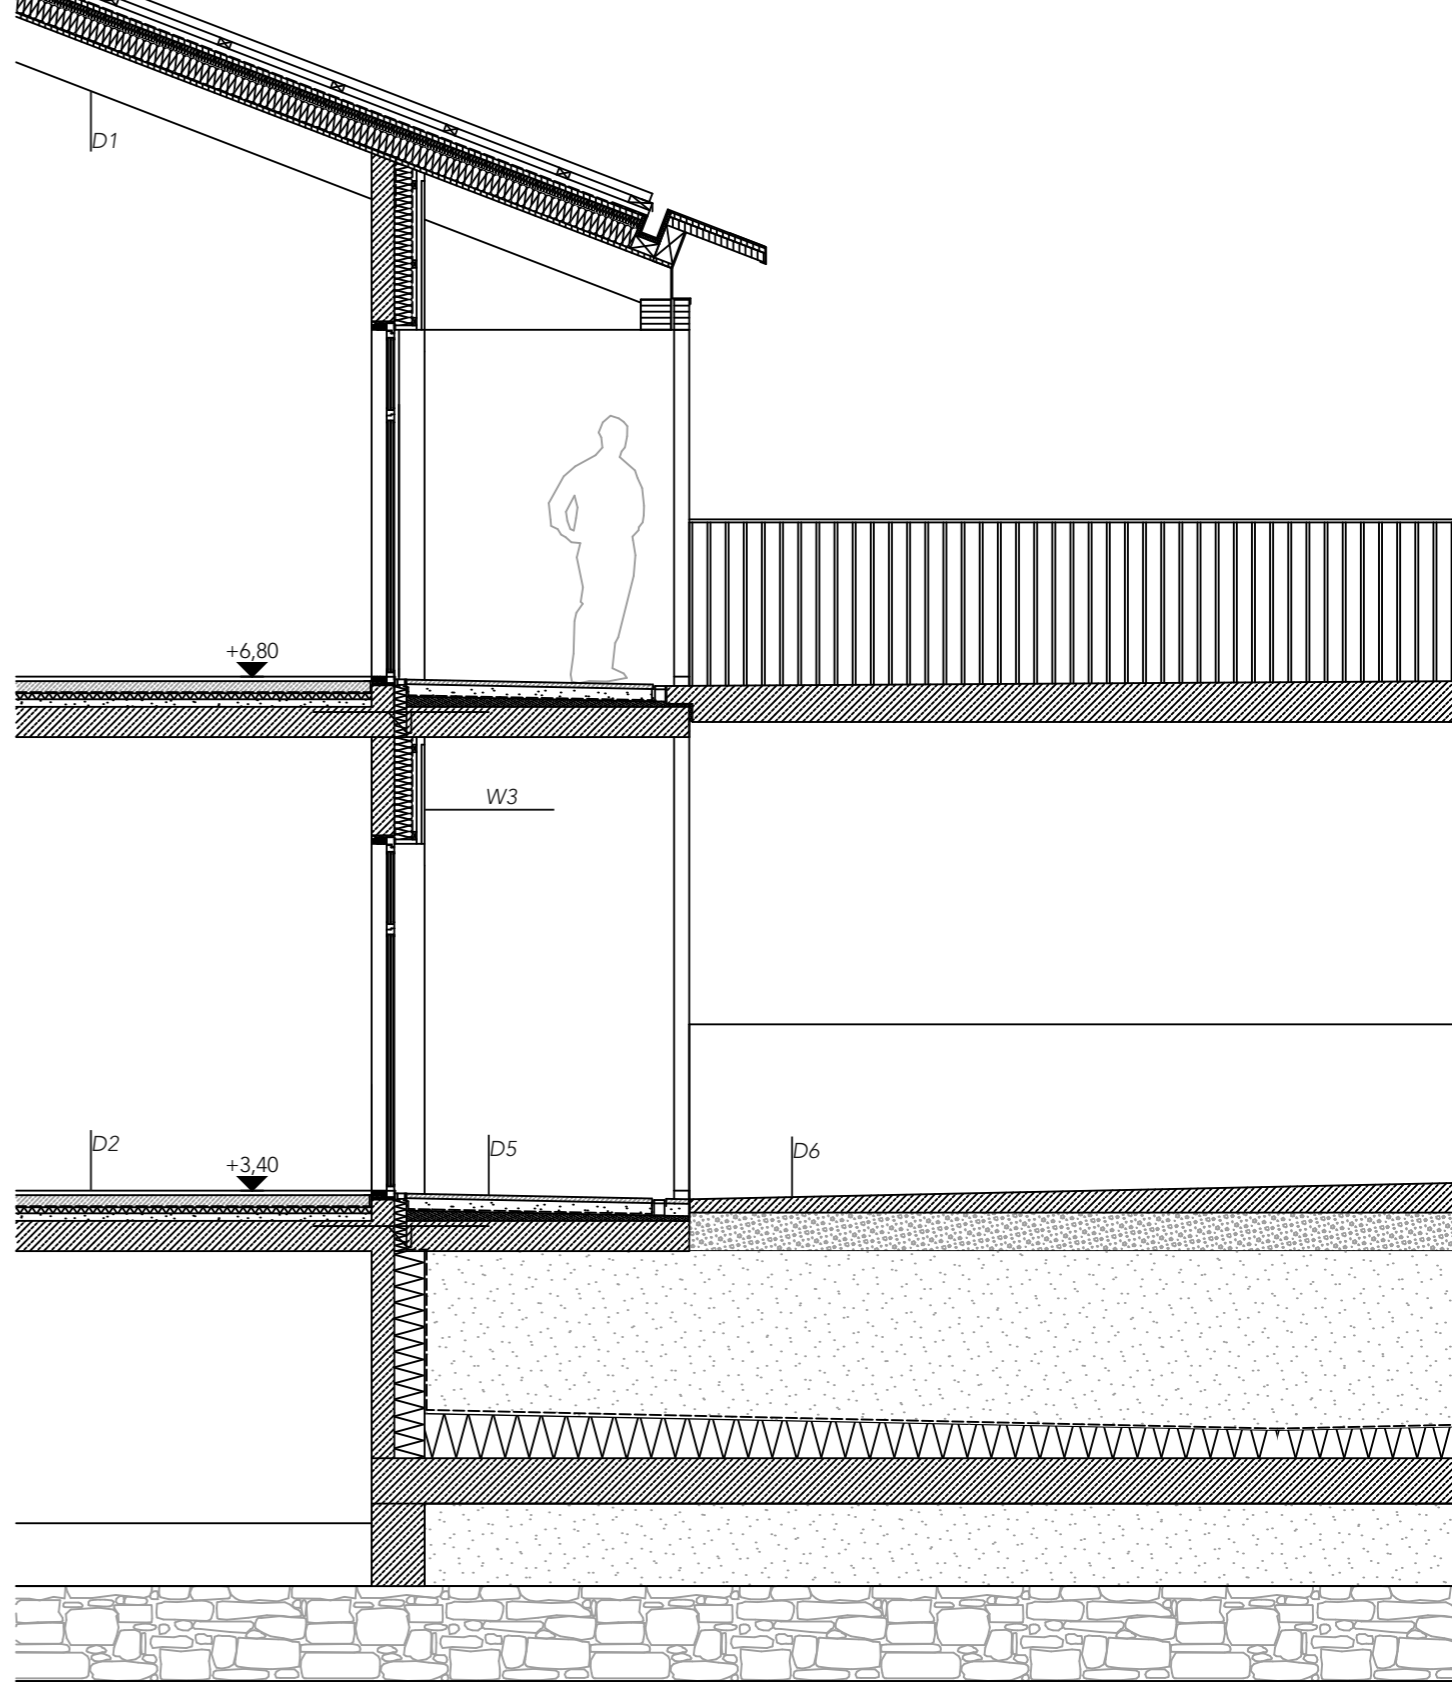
Fassadenschnitt Laubengang Hof 1 M 1:50
